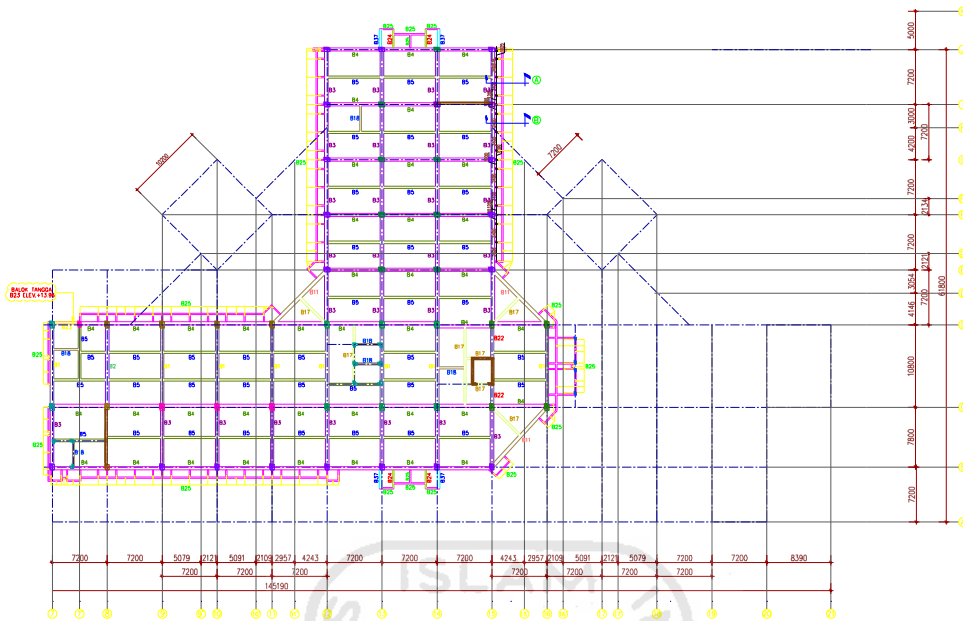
Denah Balok Gedung RSA UII Lantai 2
